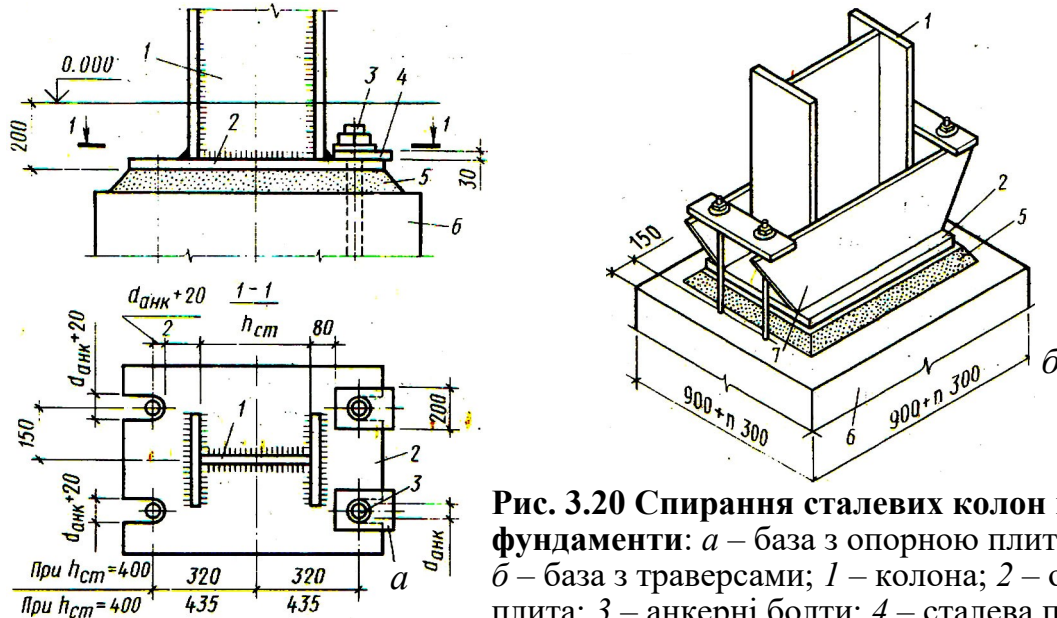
Спирання сталевих колон на фундаменти: а – база з опорною плитою; б – база з траверсами; 1 – колона; 2 – опорна плита; 3 – анкерні болти; 4 – сталевая плитка; 5 – цементний розчин; 6 – бетонний фундамент; 7 – траверса
